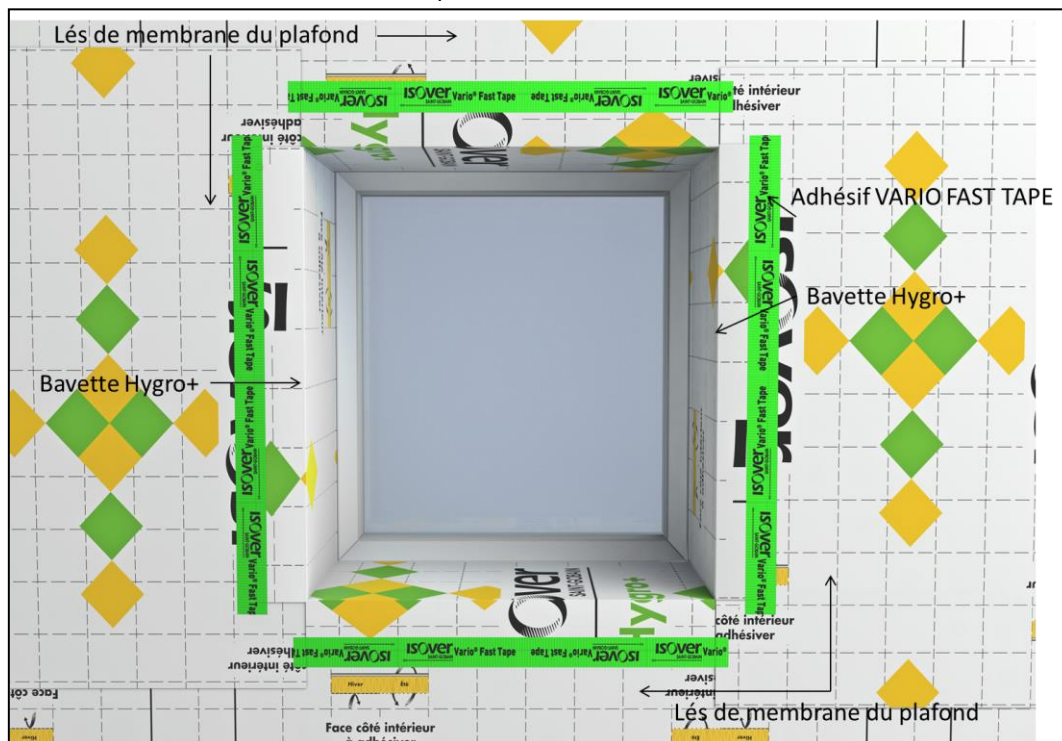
Jointoiement de la bavette ou colerette à la membrane du plafond.
